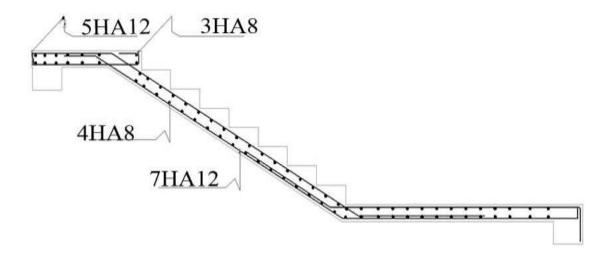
Schéma de ferraillage de l'escalier par ml.
